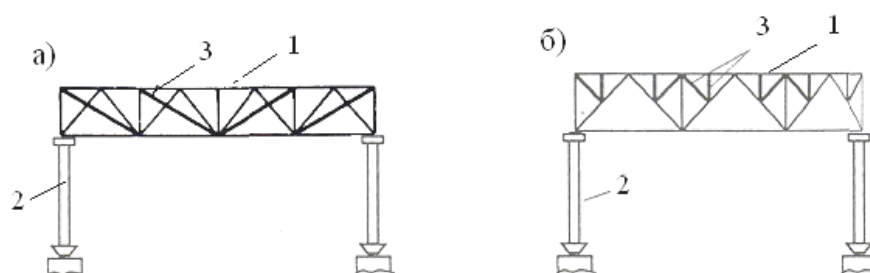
Усиление стропильных ферм путем введения дополнительных элементов решетки (а) или шпренгельных элементов решетки:
